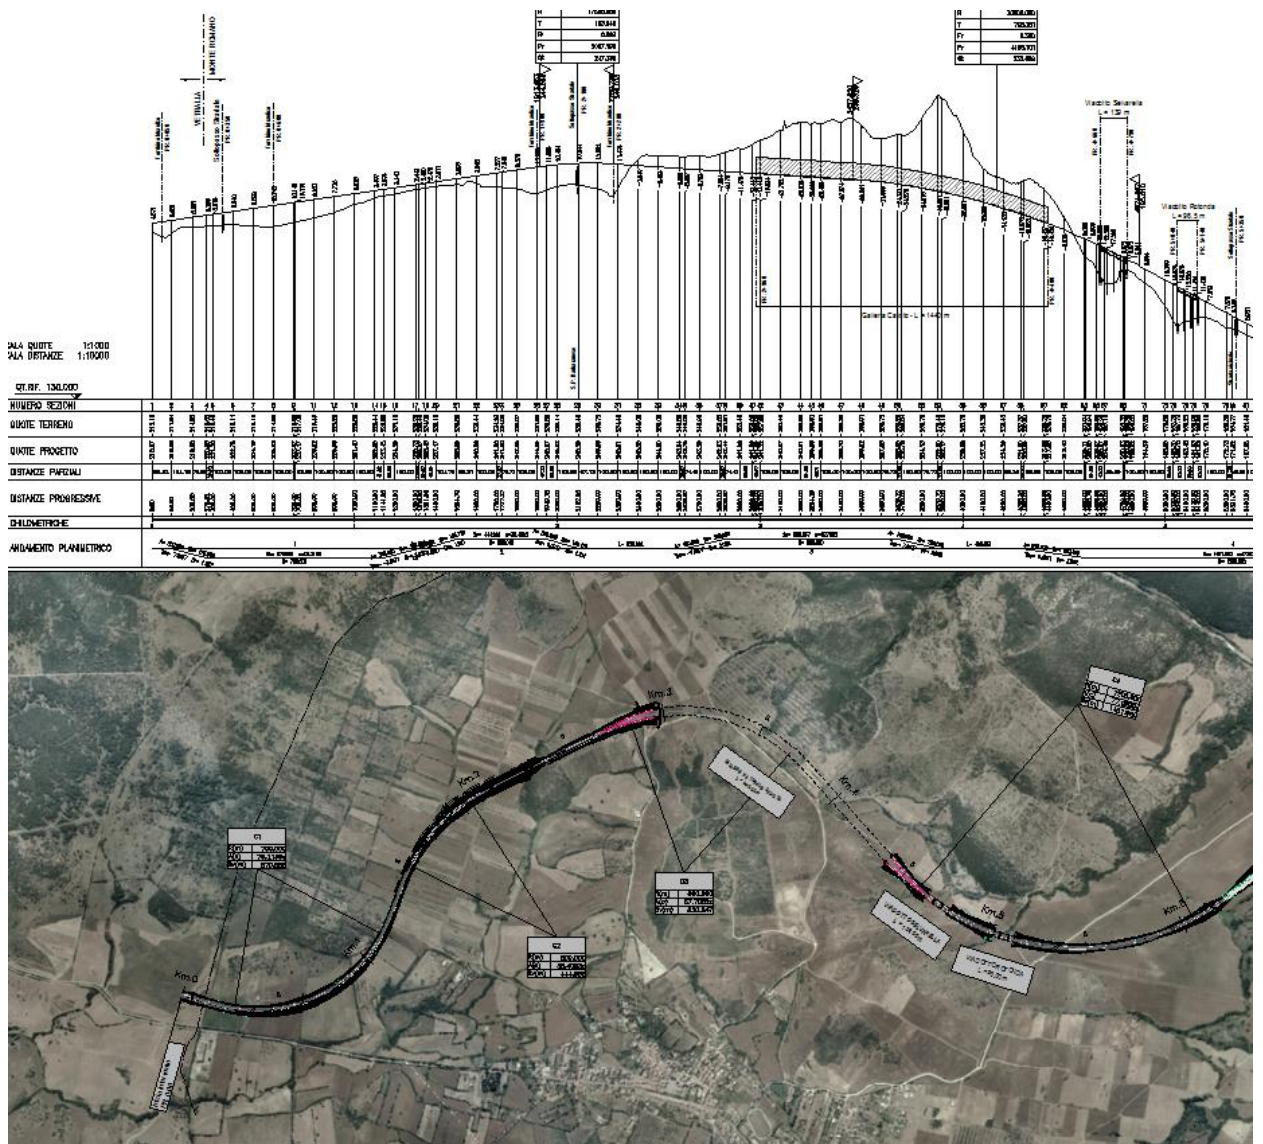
Plano-profilo tracciato Verde dal km 0 al km 6
